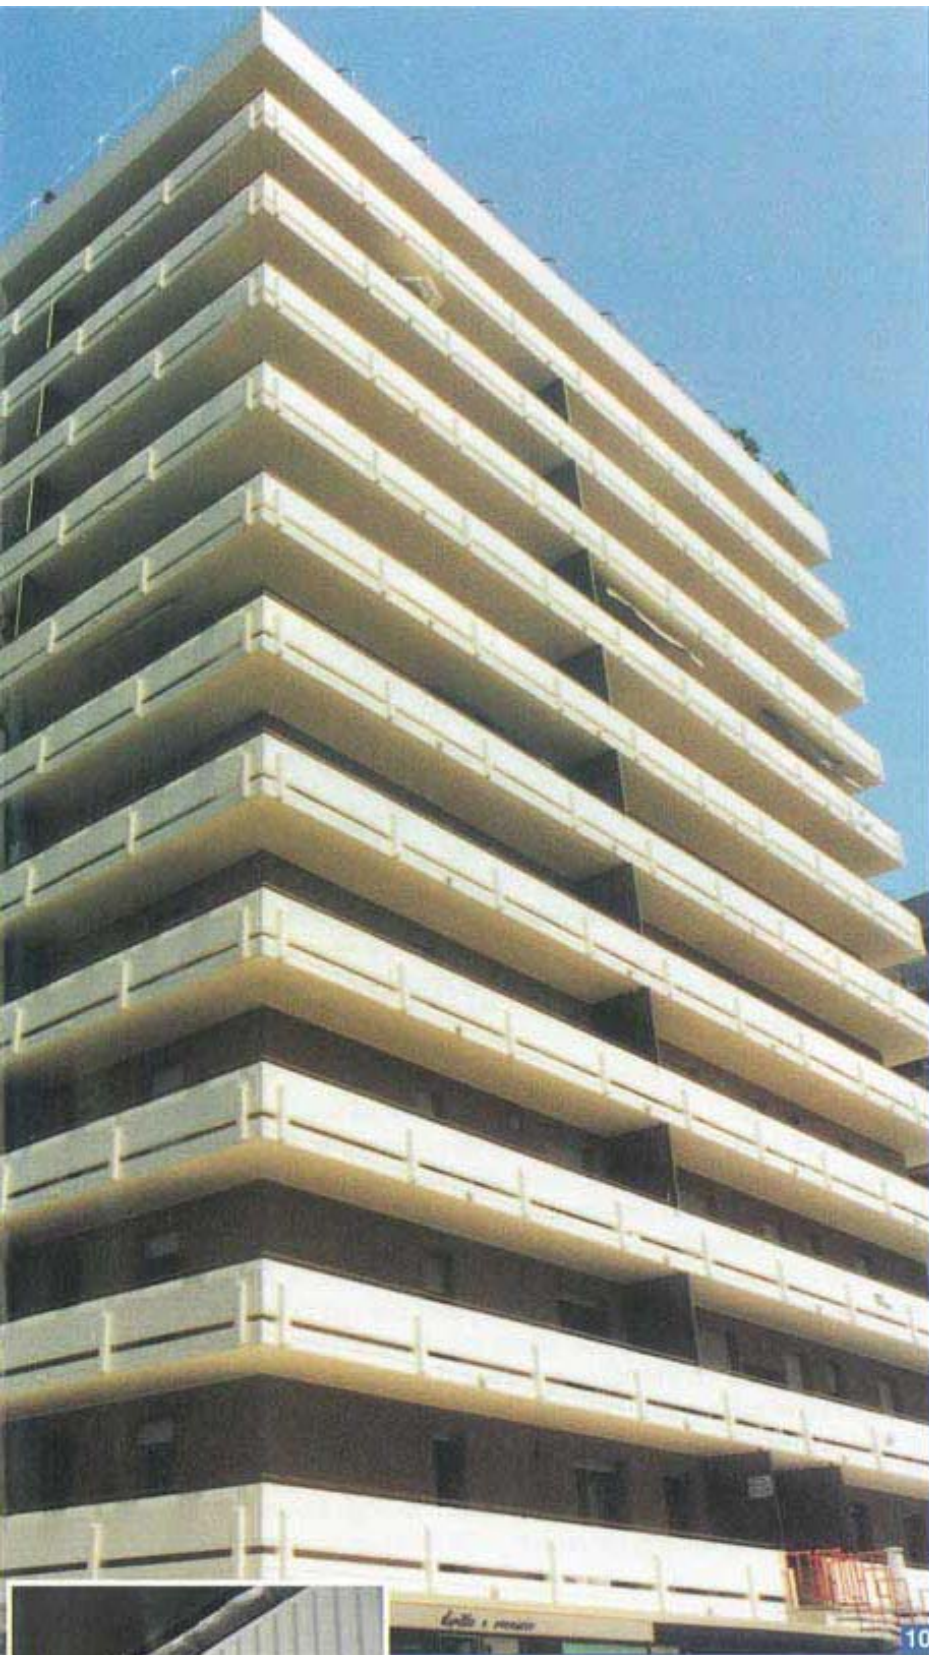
Uno dei due edifici sottoposti a restauro dopo l'intervento. Nel particolare, uno dei pilastri di sostegno dei parapetti rimesso a nuovo.
